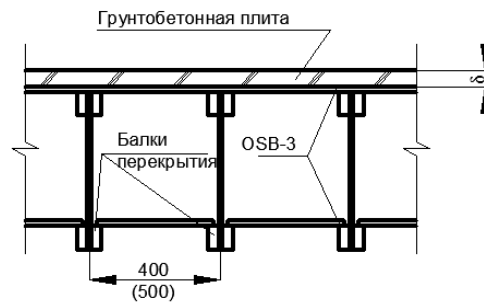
Конструктивное решение деревожелезобетонного перекрытия / Constructive decision of wood ground concrete floor
